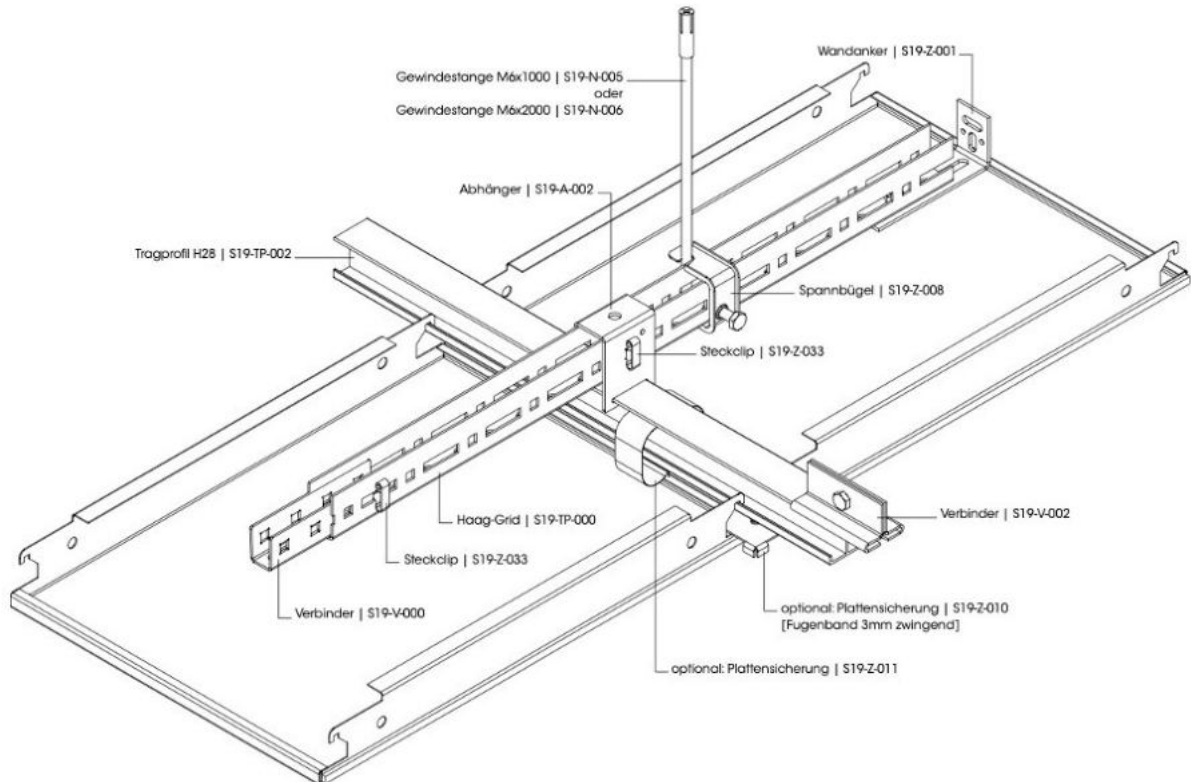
Unterkonstruktion Typ Haag 2 - H28 mit verdeckter Unterkonstruktion- Quelle www.georghaag.com
